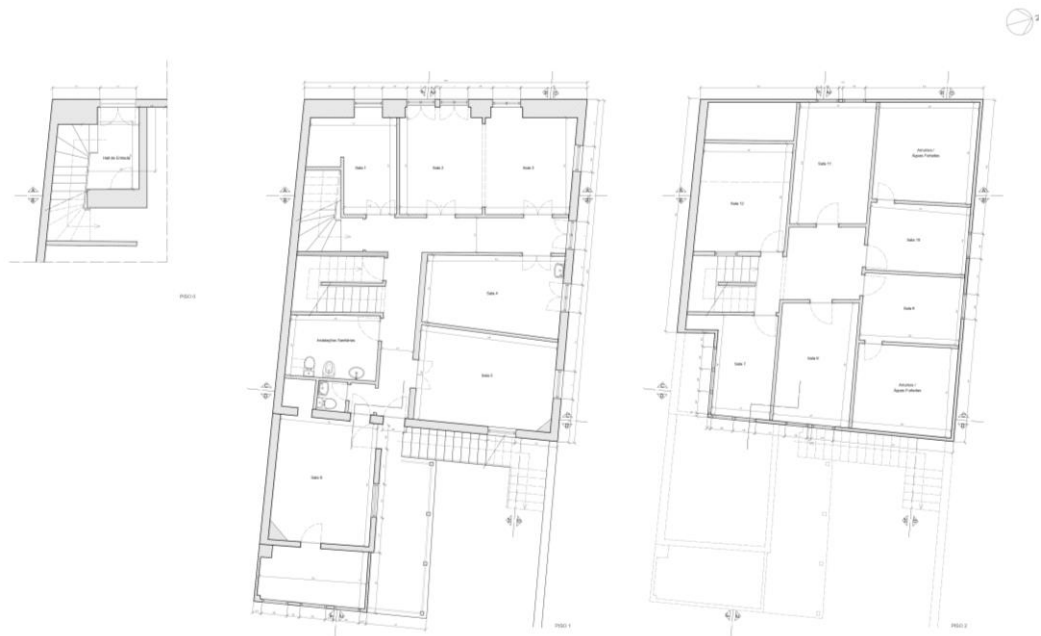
Planta de Levantamento. Fonte: Ana Ferreira
